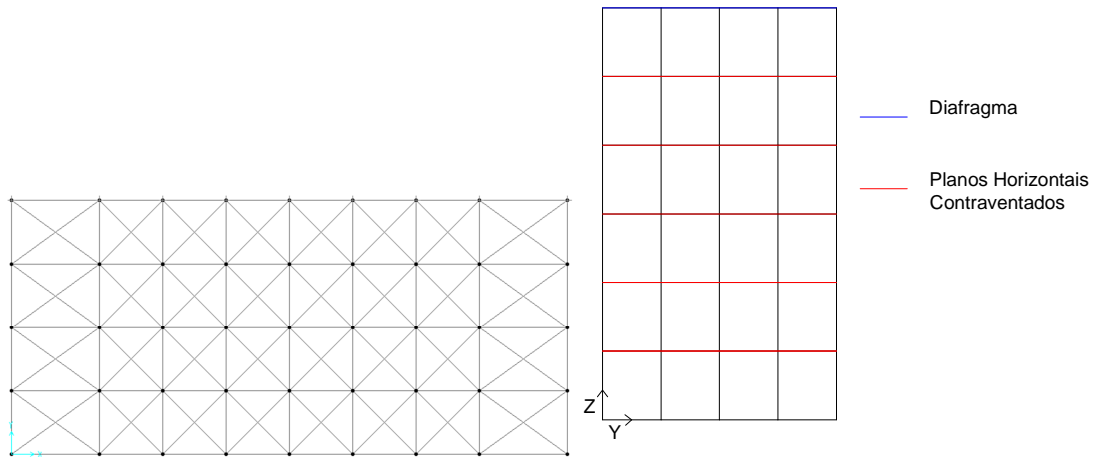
Configuração dos Planos de Contraventamento Horizontal Com Elementos de Contraventamento Pequenos
